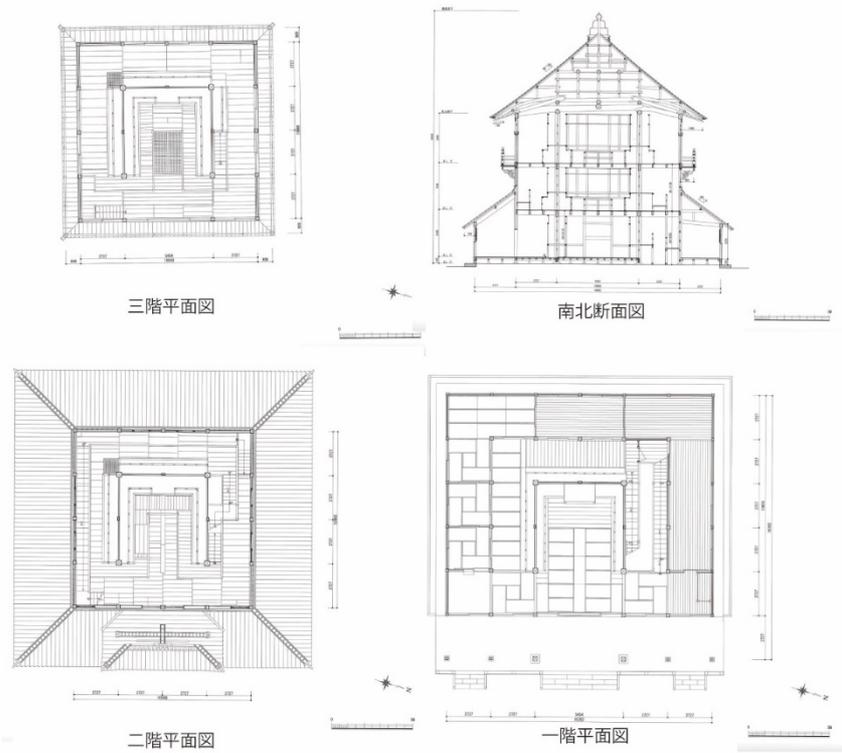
曹源寺栄螺堂の平面図・断面図¹²⁾
